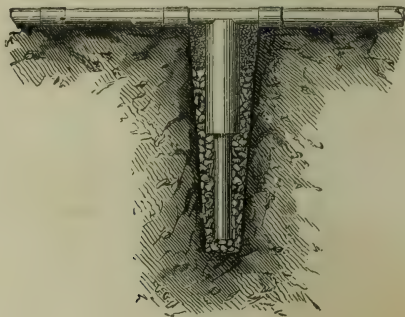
Assemblage des tuyaux verticaux et horizontaux du système de M. Rérolle.
